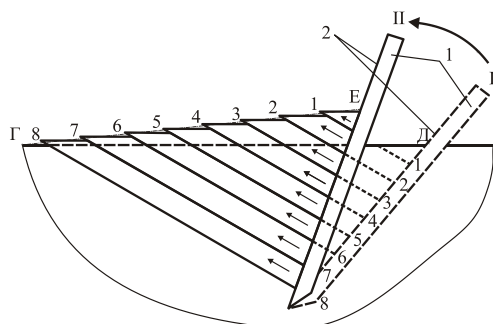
Схема разрушения грунта при работе анкерного устройства:
